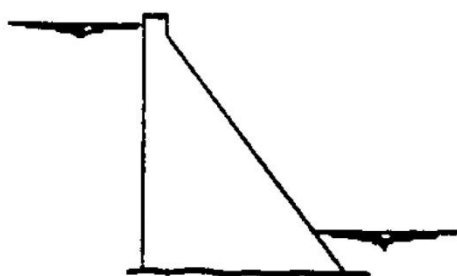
Perfil transversal de barragens de betão do tipo gravidade. Adaptado de (Quintela 1990)
